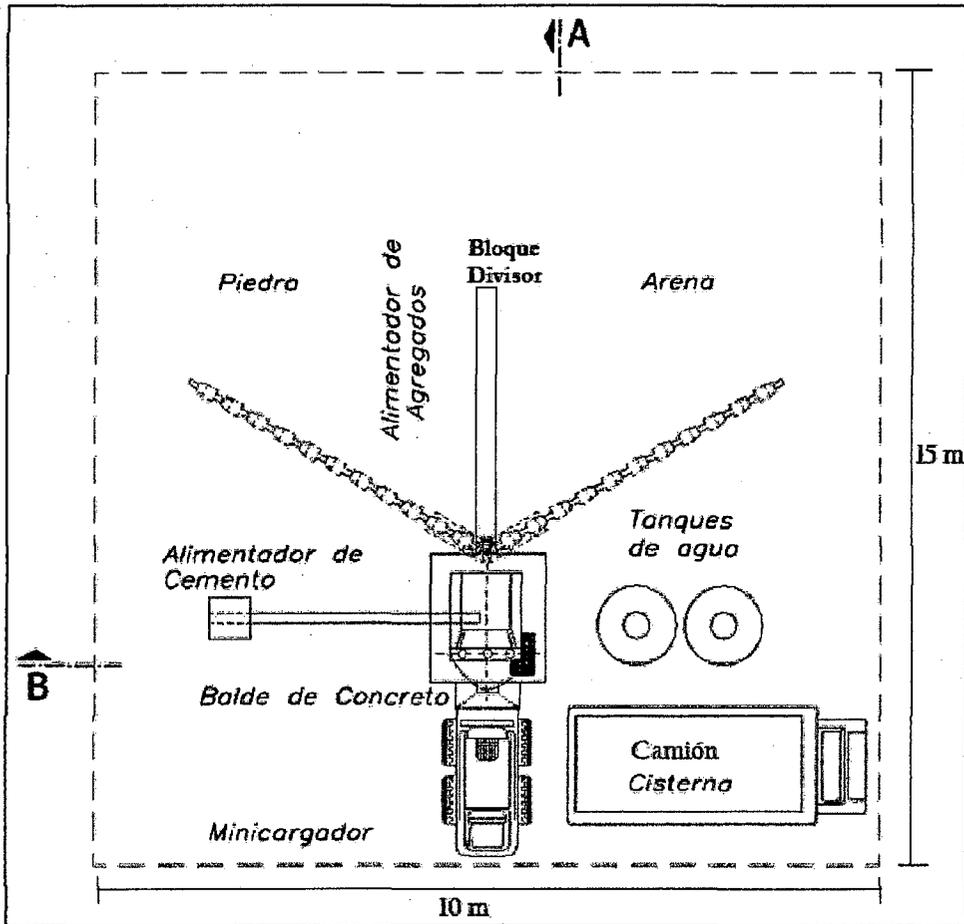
Distribución en planta de las zonas de trabajo. Fuente: Central de Equipos.
